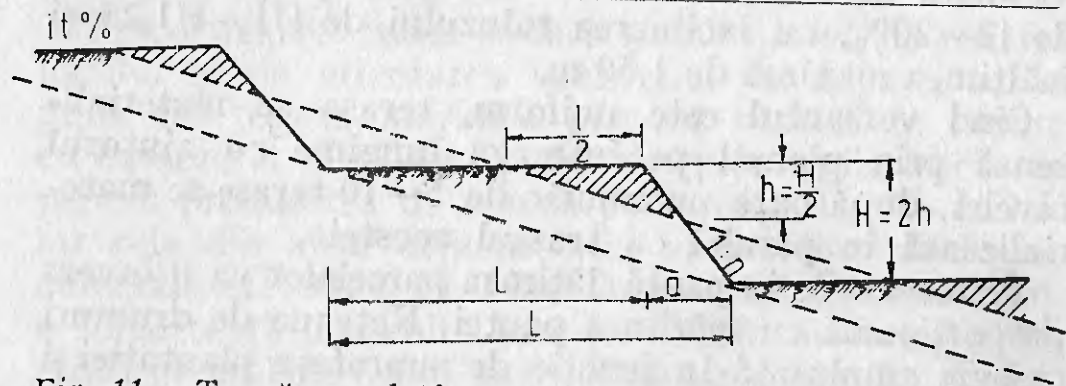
Terasă cu platformă orizontală continuă și elementele constructive:
